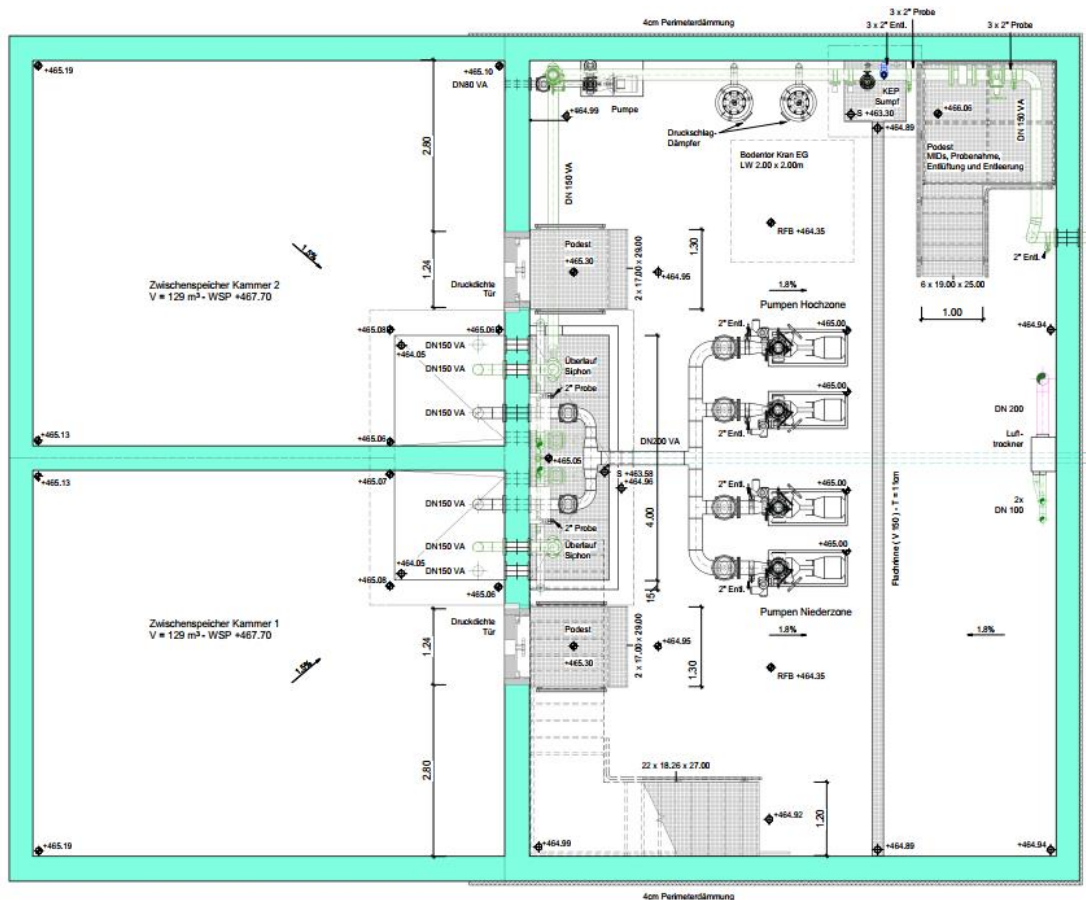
Schnitt Untergeschoss Pumpstation aus Planbeilage L3786.302.
